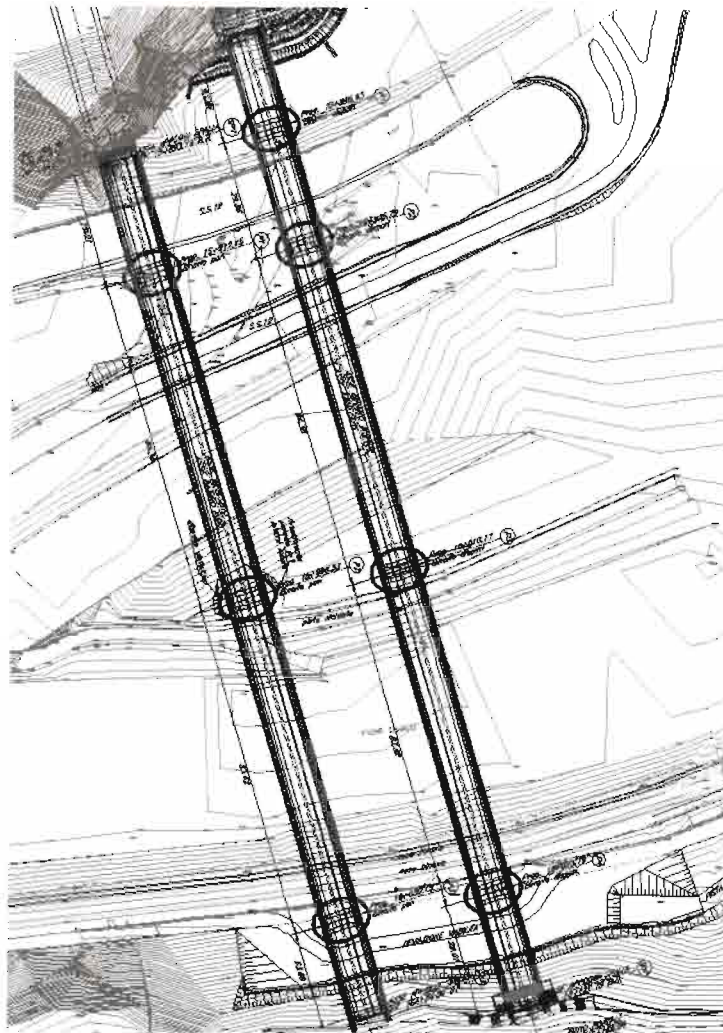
Ponte Fiume Isarco: Planimetria di progetto
